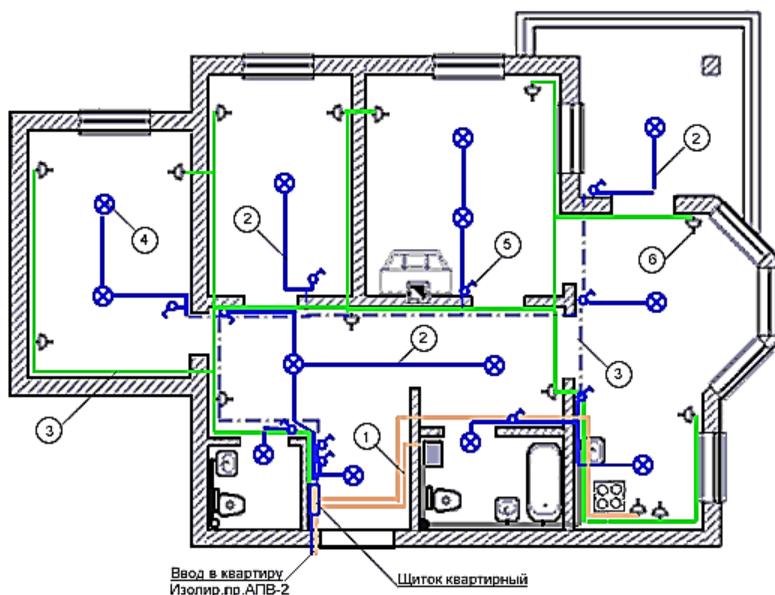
План квартиры со схемой скрытой электропроводки:
